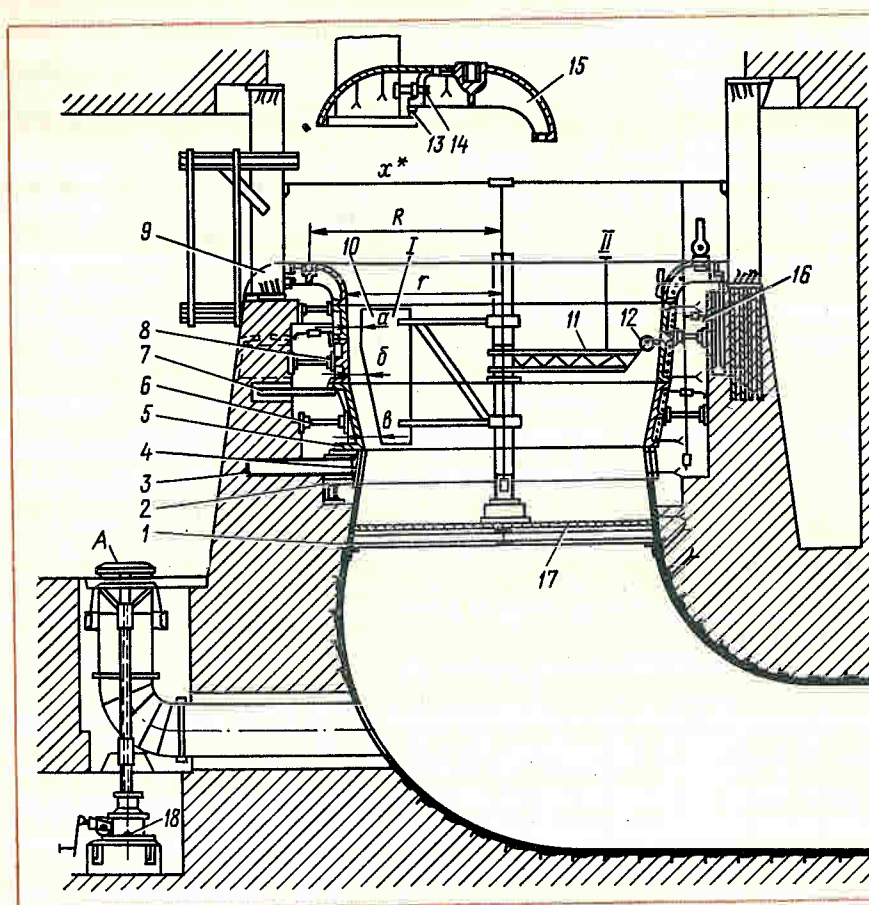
Схема монтажа камеры рабочего колеса и нижнего кольца направляющего аппарата:
